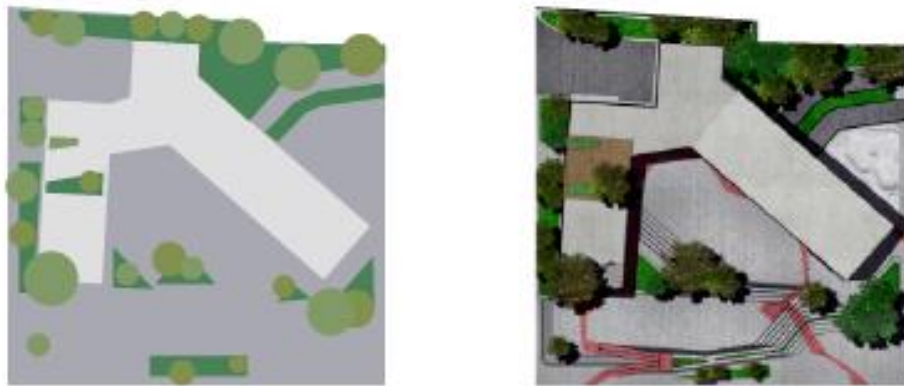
Planta de conjunto y distribución de áreas verdes del proyecto. Elaboración propia.
